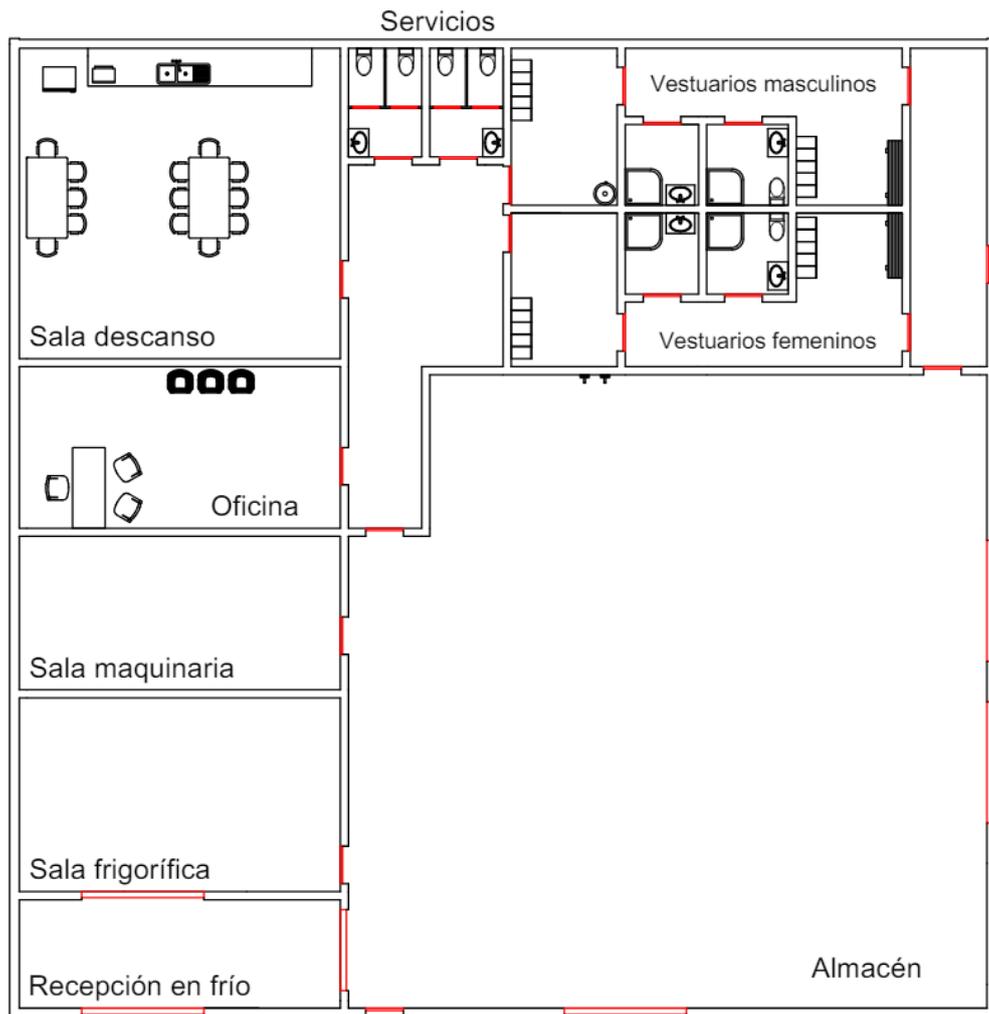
Distribución en planta Nave Complementaria. Fuente: Elaboración propia.
